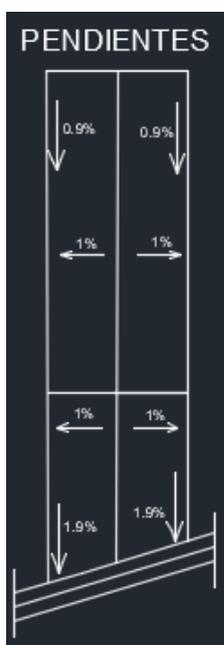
Plano de planta con pendientes. Fuente: Propia.
